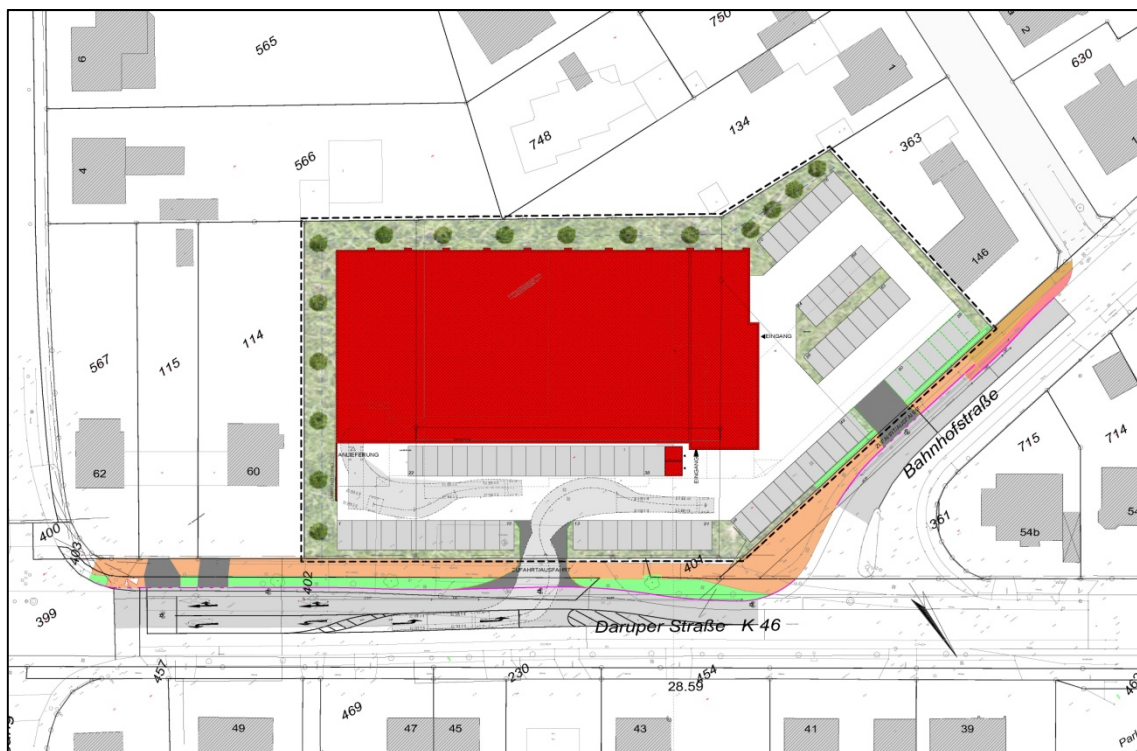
Lageplan zum Bauvorhaben (Brüninghoff GmbH & Co. KG, Heiden)
